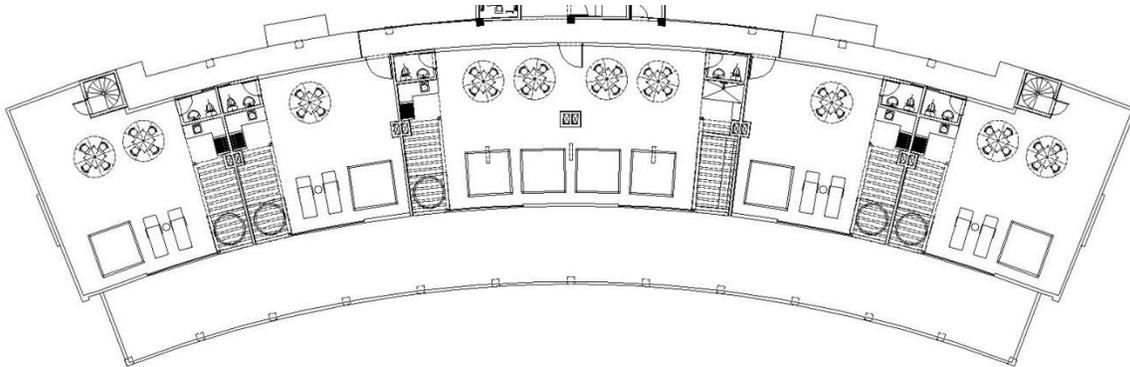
24. Planta Arquitectónica Nivel 7 tipo (M7P).
